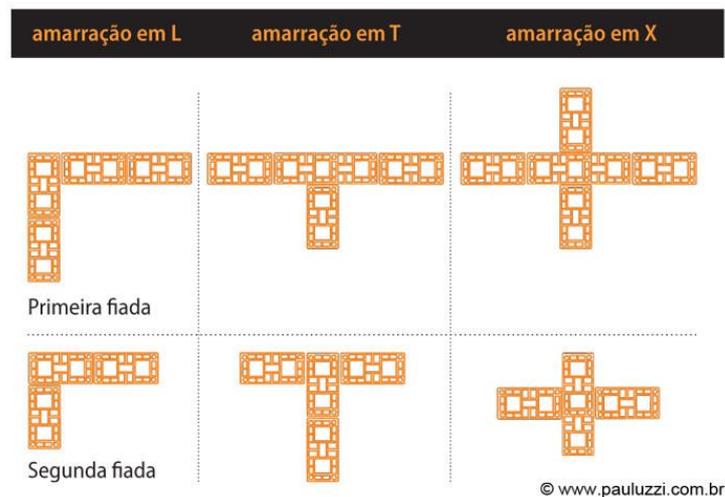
Tipos de amarrações diretas entre paredes estruturais.
